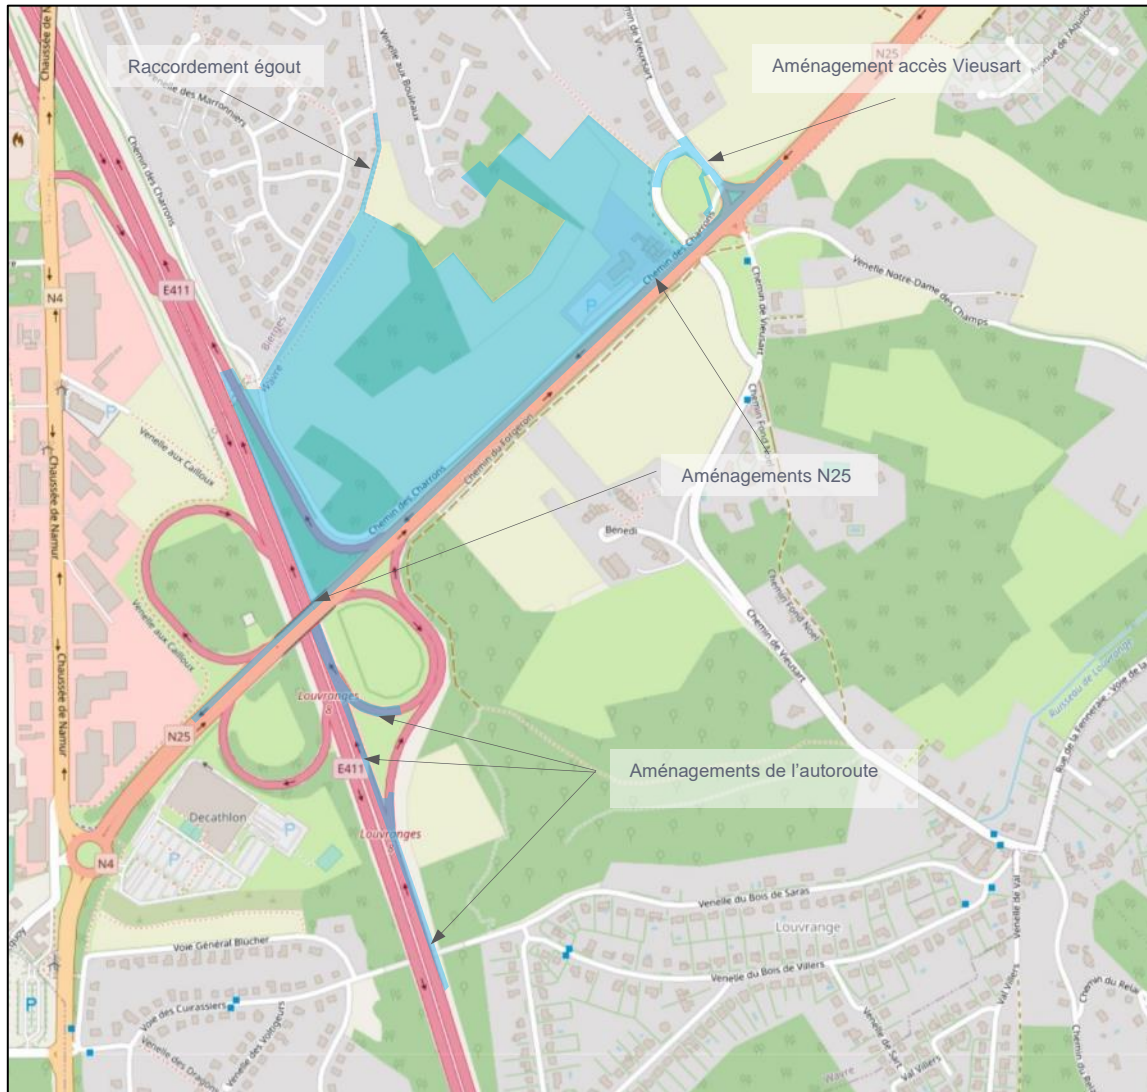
Périmètre d'intervention (en bleu) (source du fond de plan : OpenStreetMap)
